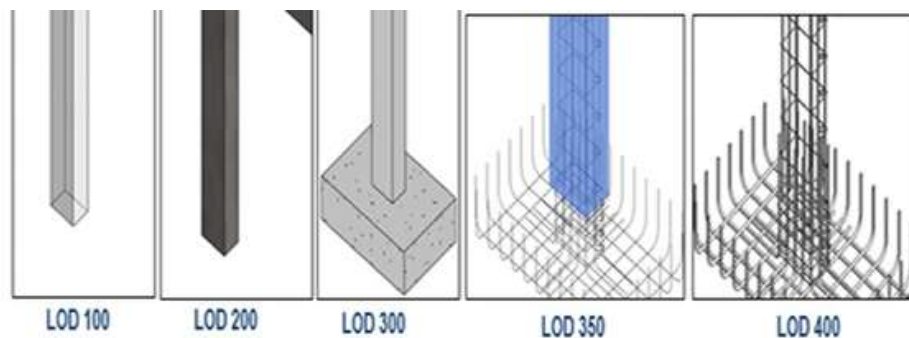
Explicación gráfica de los niveles LOD en detalles estructurales de concreto reforzado
